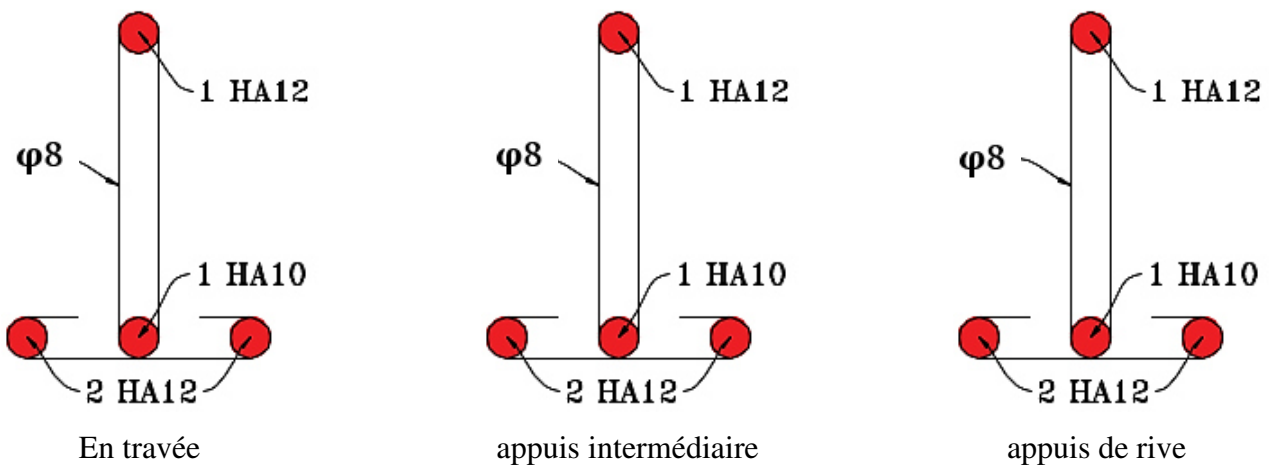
Schémas de ferrillage des poutrelles étage courant
